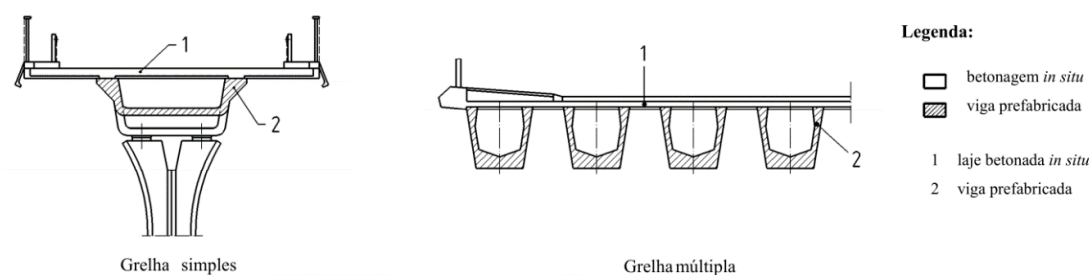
Configuração de uma ou mais vigas pré-fabricadas em U (NP EN 15050, 2008)
